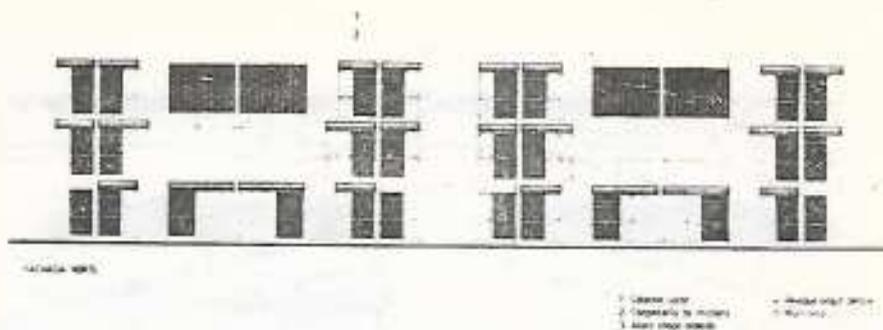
Fachada norte de viviendas en cinta con muro solar
